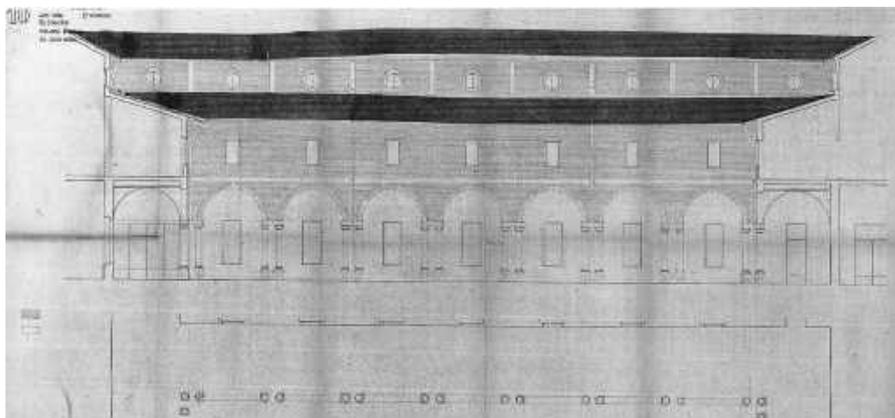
Primo chiostro, prospetto est, progetto di restauro
